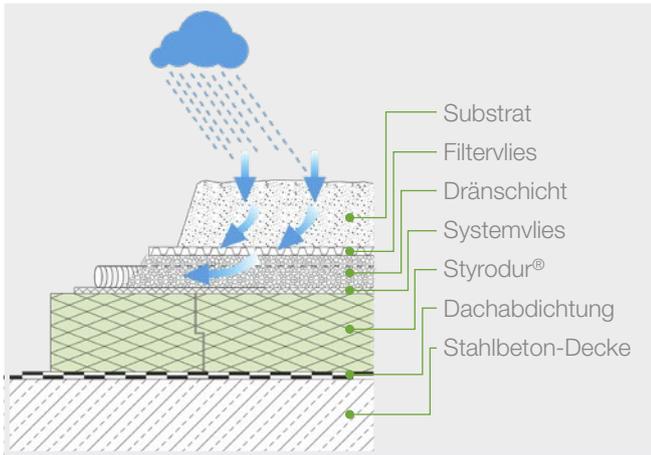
Schichtenaufbau eines begrünten Umkehrdaches mit Dränschicht zur flächigen Wasseraufnahme und alternativ mit Dränleitung.
